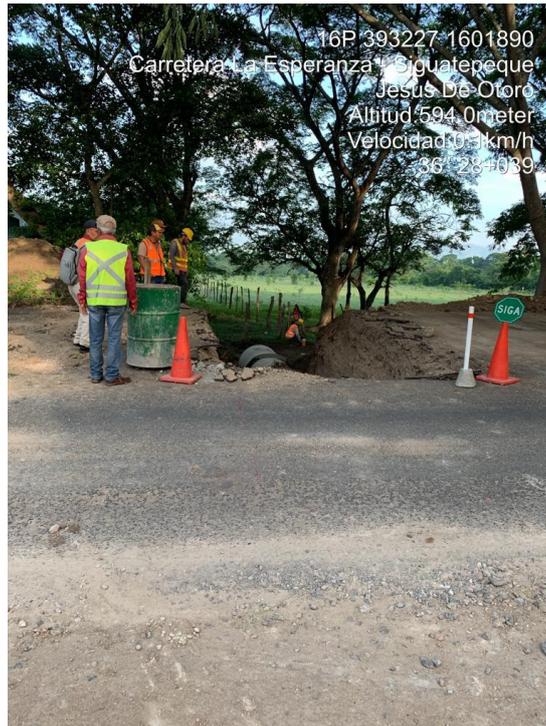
Aterrado de 4 tubos que componen alcantarilla
